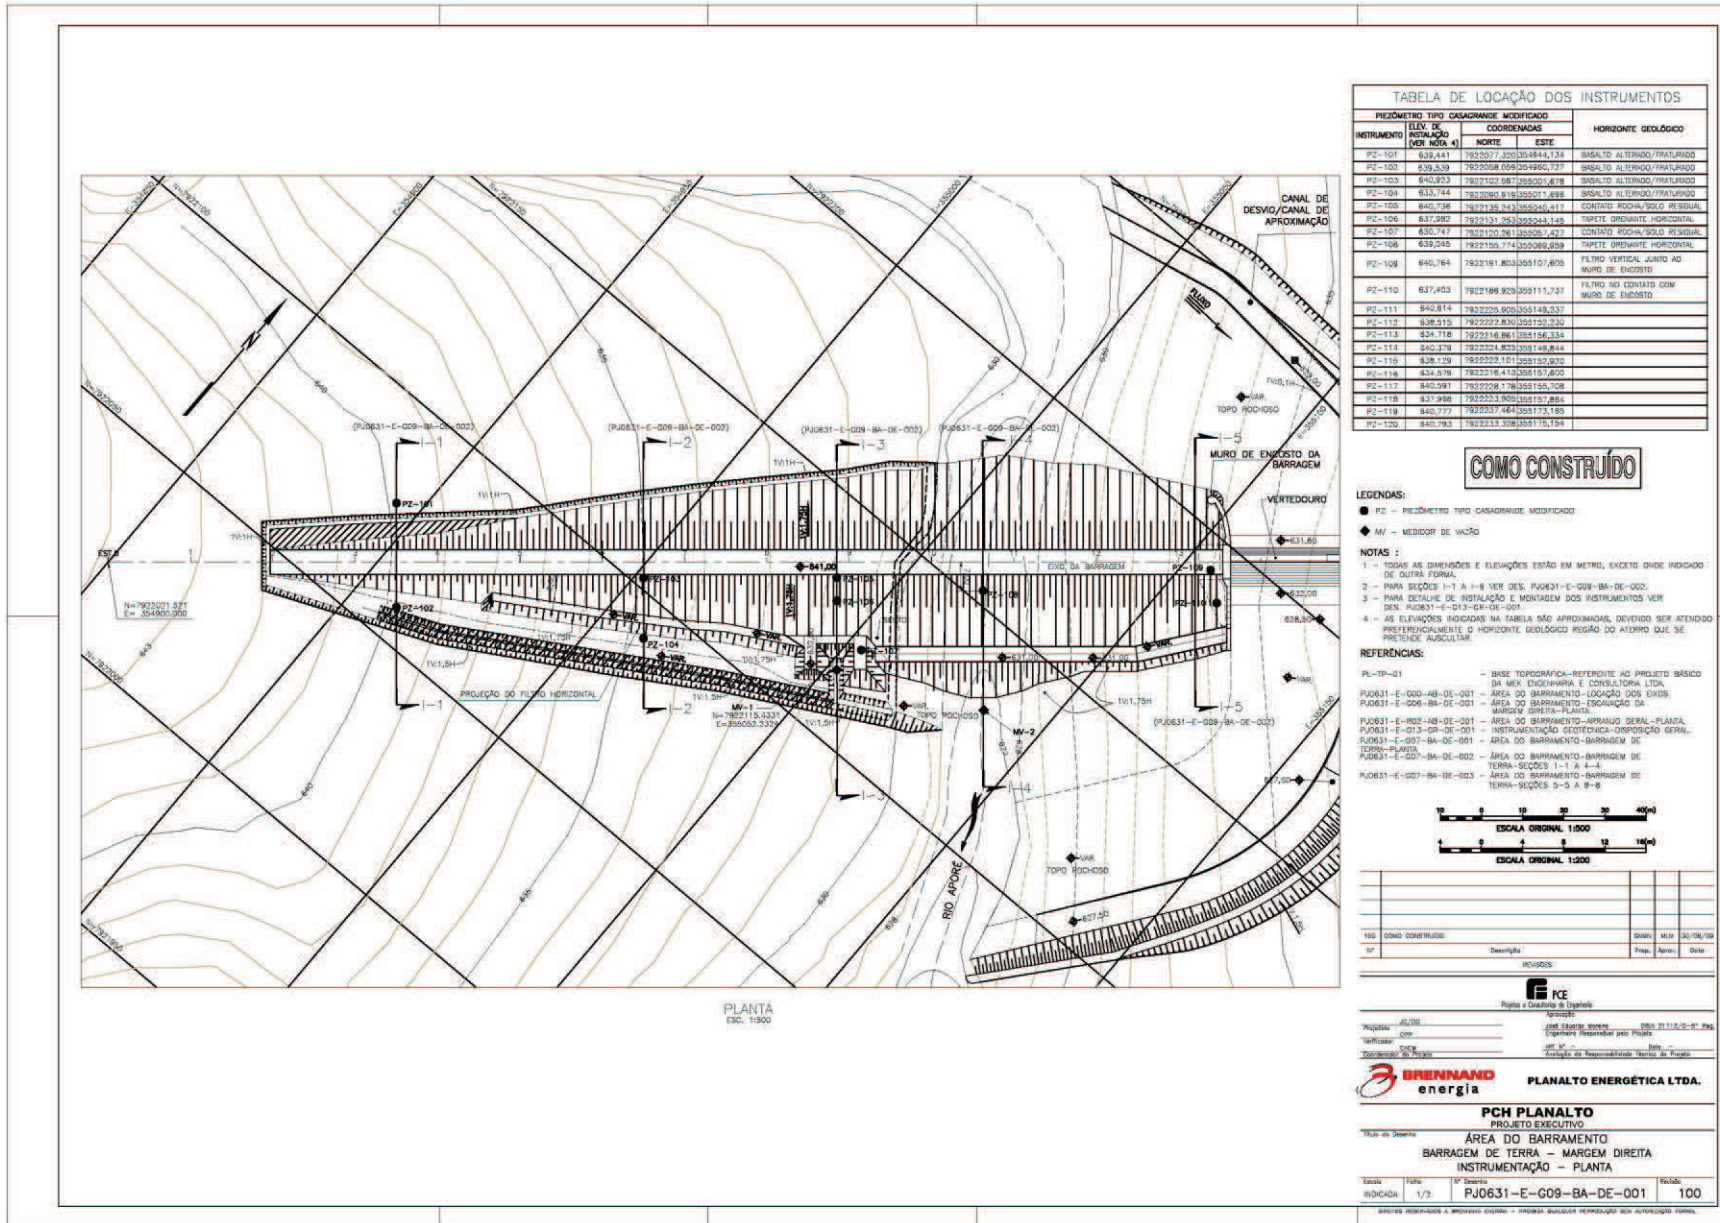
Barragem Margem Direita – Instrumentação Planta
